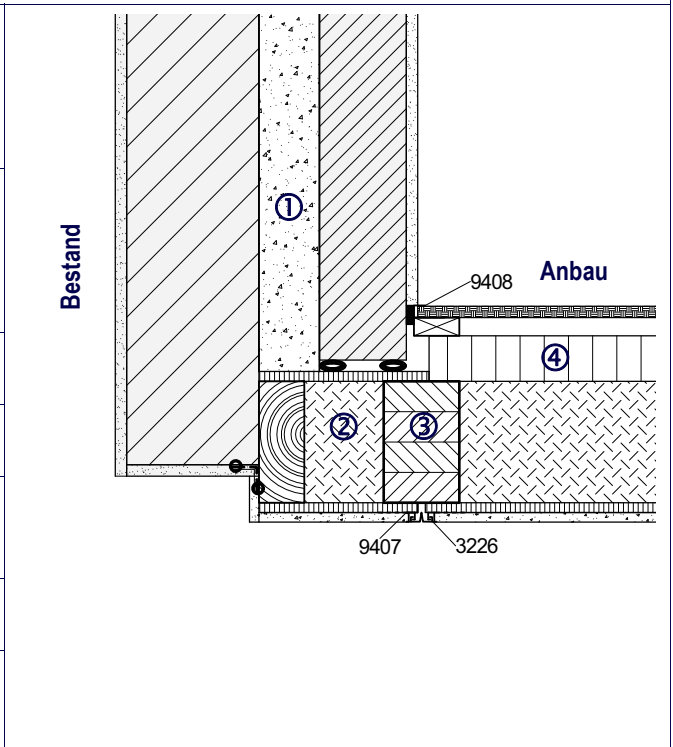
Außenwandanschluss bei zweischaligem Mauerwerk, Ausführung als gleitender Anschluss
